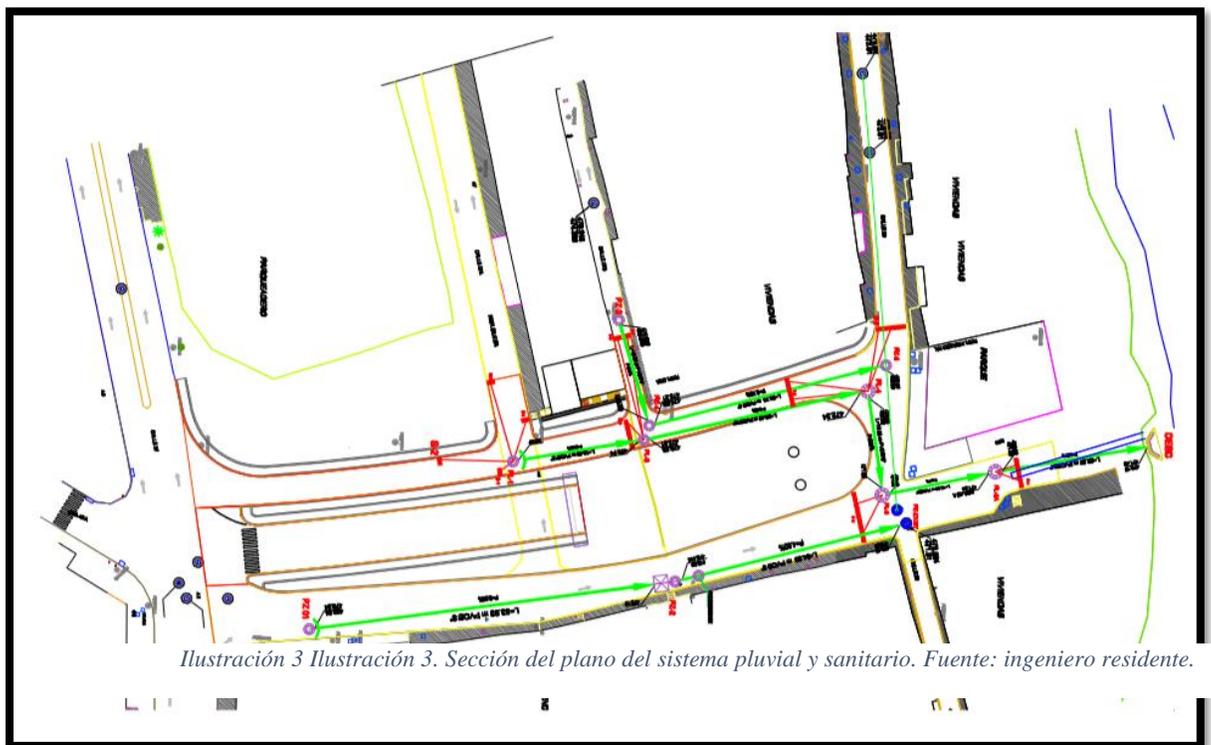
Ilustración 3. Sección del plano del sistema pluvial y sanitario. Fuente: ingeniero residente.
